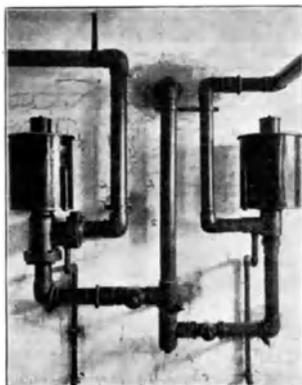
Gasverteilung für das Erdgeschoß und I. Stockwerk im östlichen Laboratoriengebäude (Raum 556).
